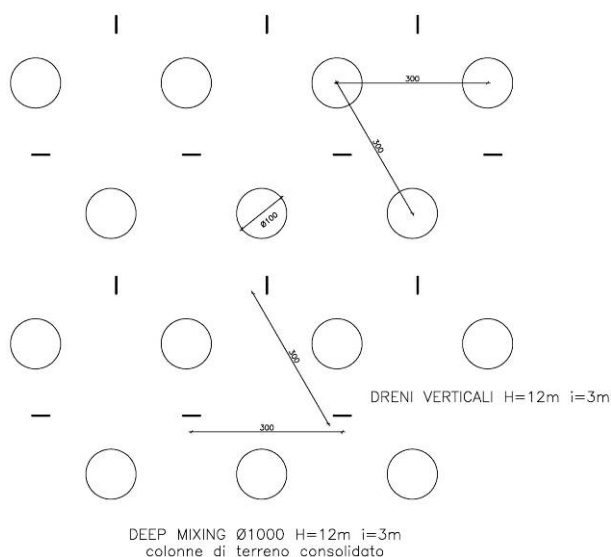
disposizione planimetrica delle colonne di terreno consolidato tramite deep mixing.
